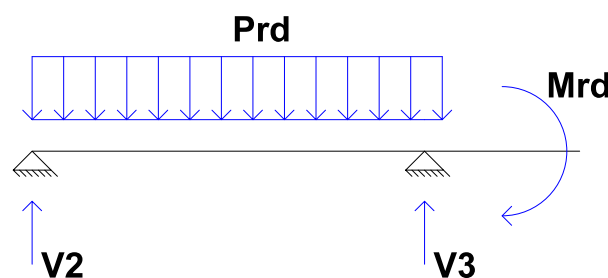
Modelo para o cálculo da reação das lajes nas vigas.
